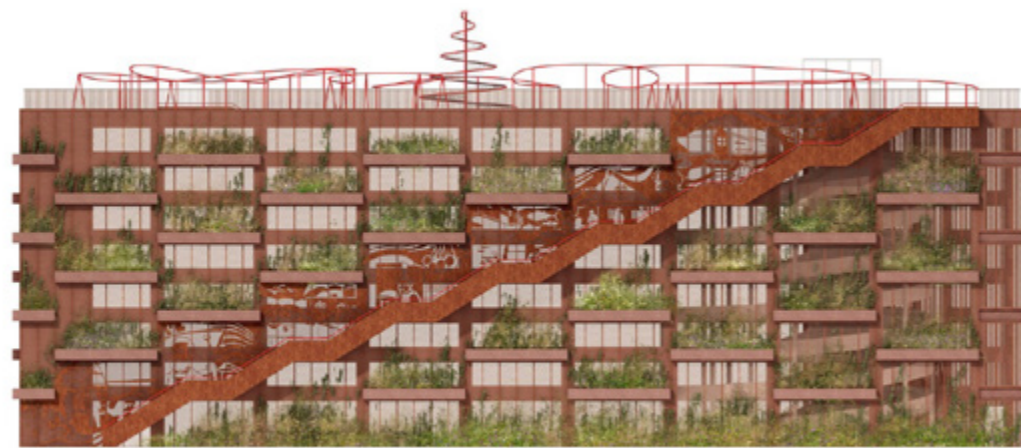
Fachada do Park 'n Play. Retirada do site: <<https://www.archdaily.com.br/885539/park-n-play-jaja-architects>>
